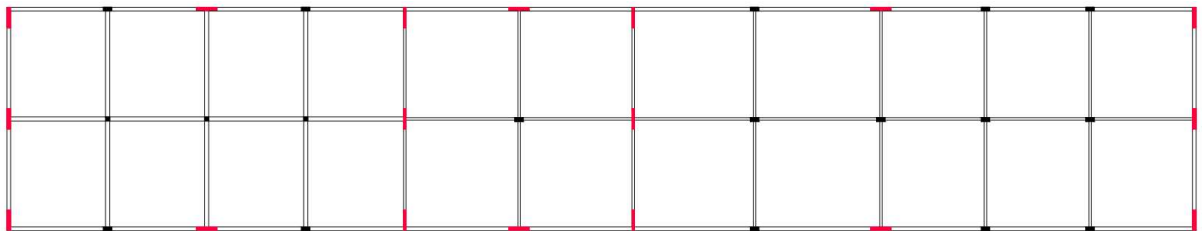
Distribución de tabiques rígidos en la estructura.
